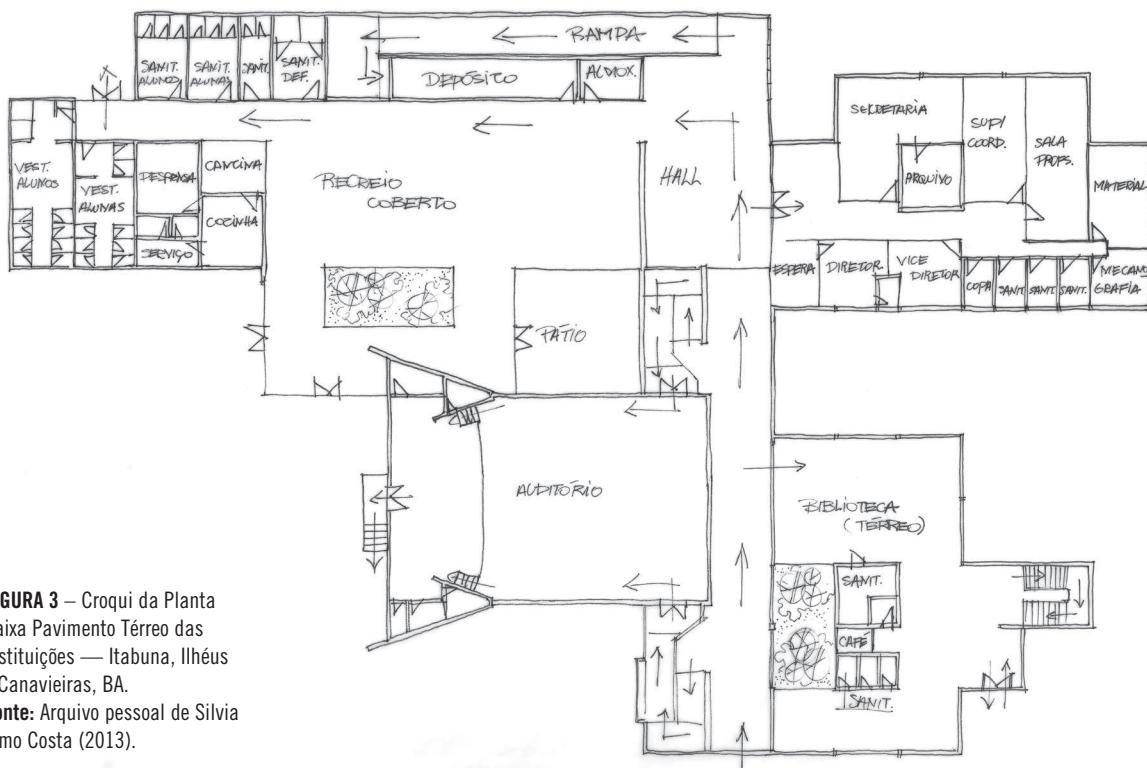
Croqui da Planta Baixa Pavimento Térreo das Instituições — Itabuna, Ilhéus e Canavieiras, BA.
